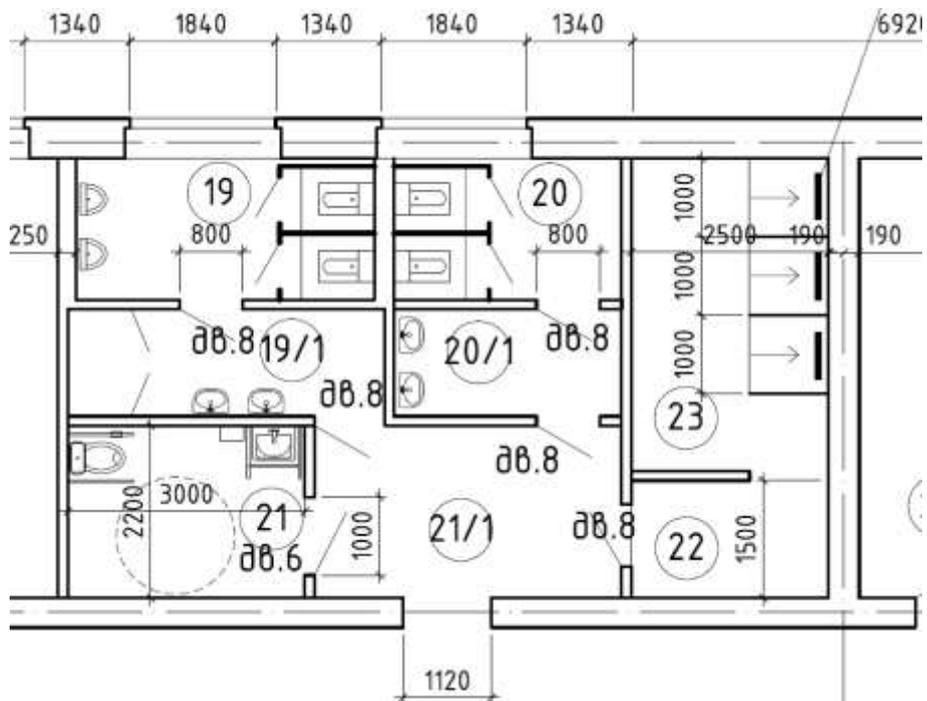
Санітарні приміщення цокольного поверху після реконструкції (19 – чоловіча вбиральня; 19/1 – умивальник; 20 – жіноча вбиральня; 20/1 – умивальник; 21 – інклюзивна вбиральня; 21/1 – коридор; 22 – роздягальня; 23 – душова)
